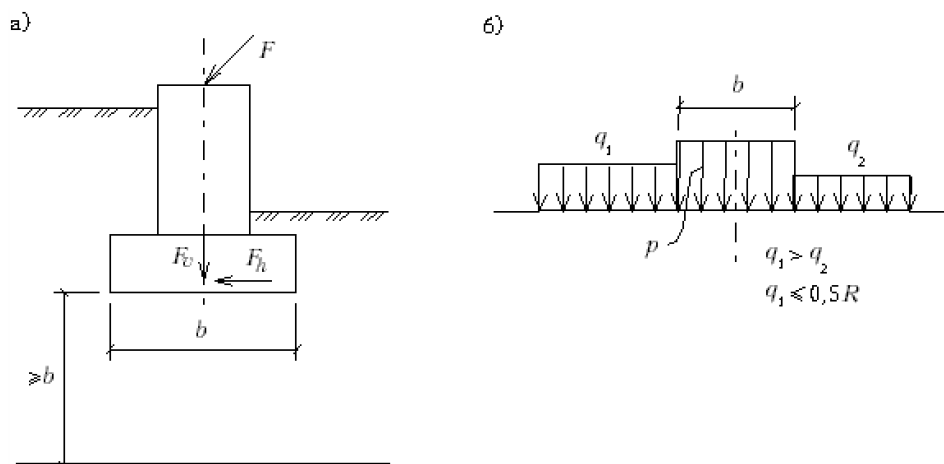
Визначення граничного опору ґрунту основи: а – схема навантаження фундаменту; б – розрахункова схема
